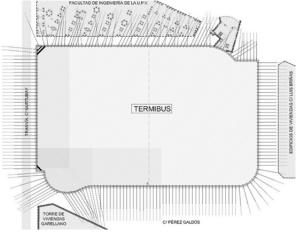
Nueva Estación Intermodal Soterrada de Termibus. Muro pantalla perimetral anclado.
